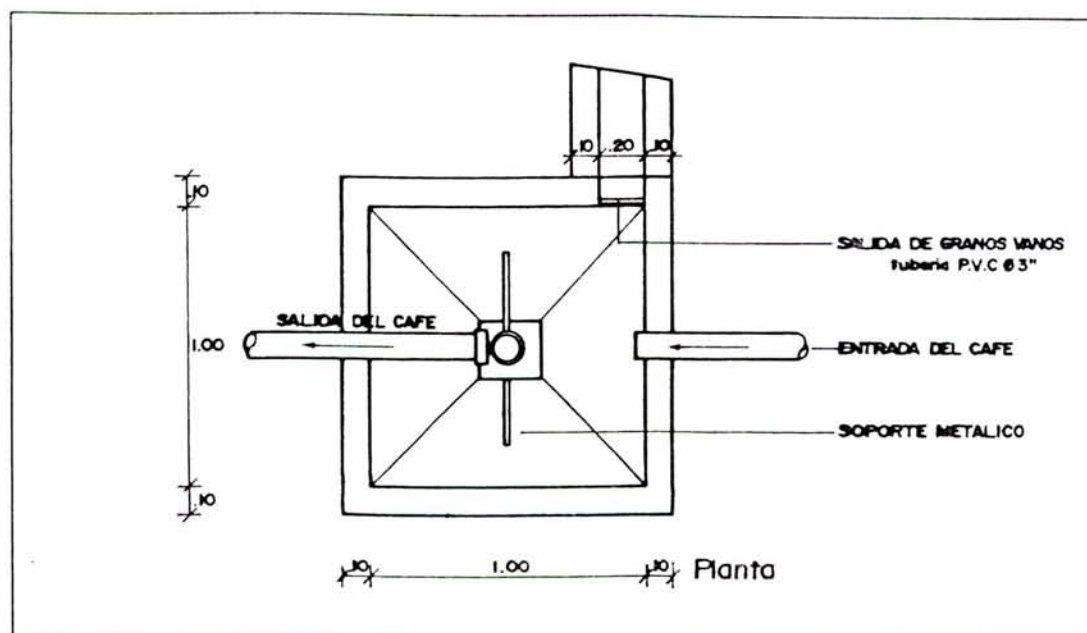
Vista en Planta de un Tanque Sifón.
